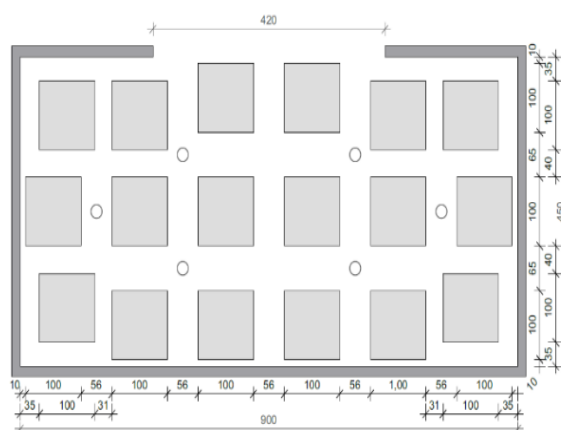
Grundriss mit Anordnung der Holzkippen von Versuch V3 [7], Maße in cm
